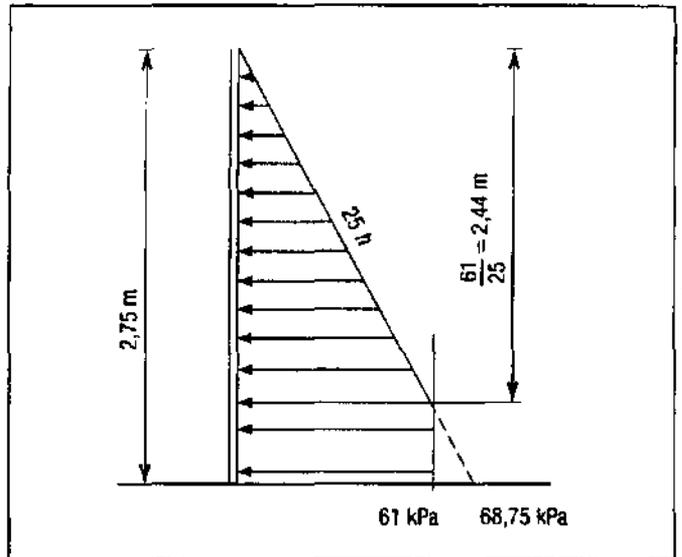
Poussée du béton sur le coffrage d'un voile de 16 cm.
